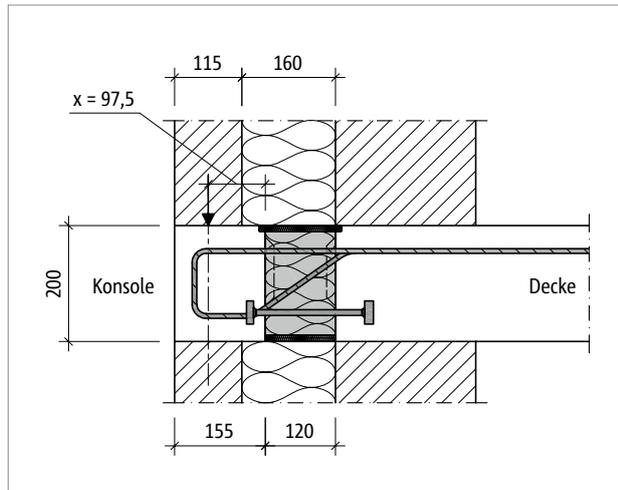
Schöck Isokorb® XT Typ O: Wandaufbau für Bemessungsbeispiel
